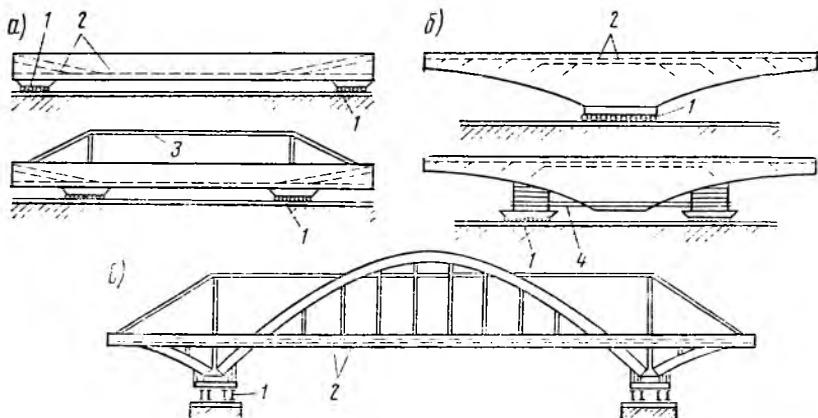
Схема расположения перекаточных устройств для конструкций разных систем.
